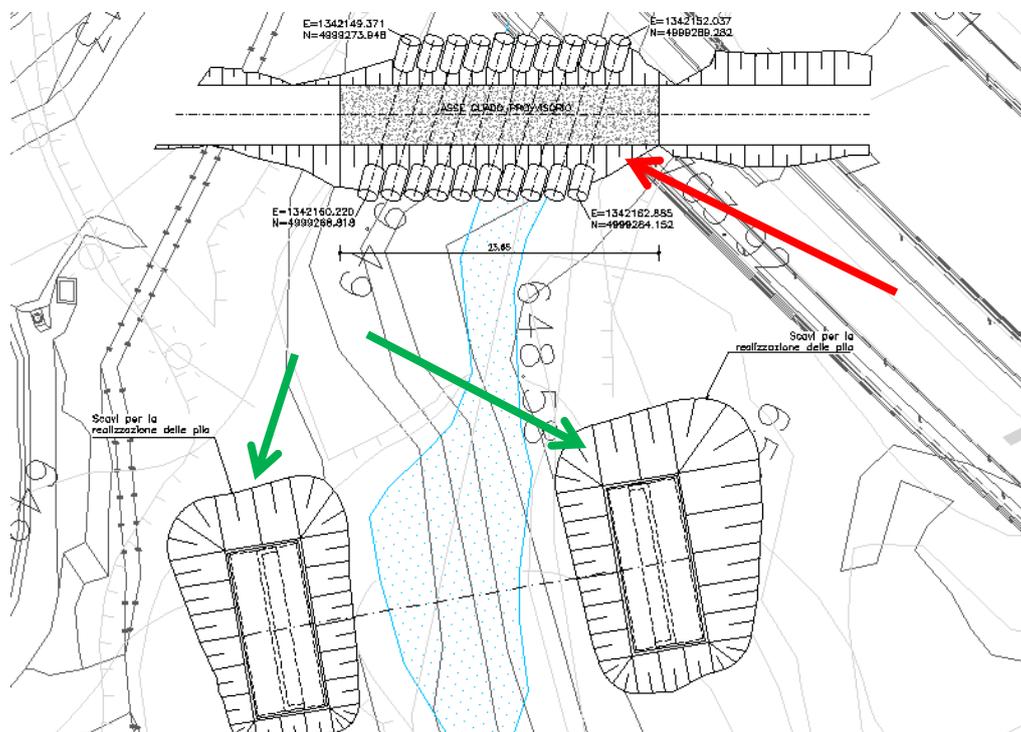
Guado provvisorio indicato con freccia rossa. Con freccia verde sono indicati gli scavi per la realizzazione delle spalle del Ponte Bailey
